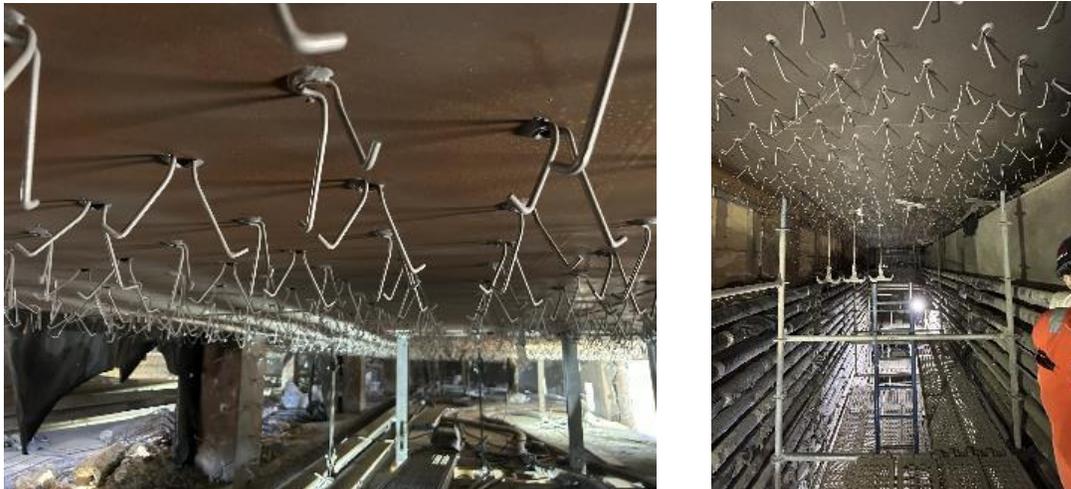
Anclas instaladas en techos. Fuente: Propia.
